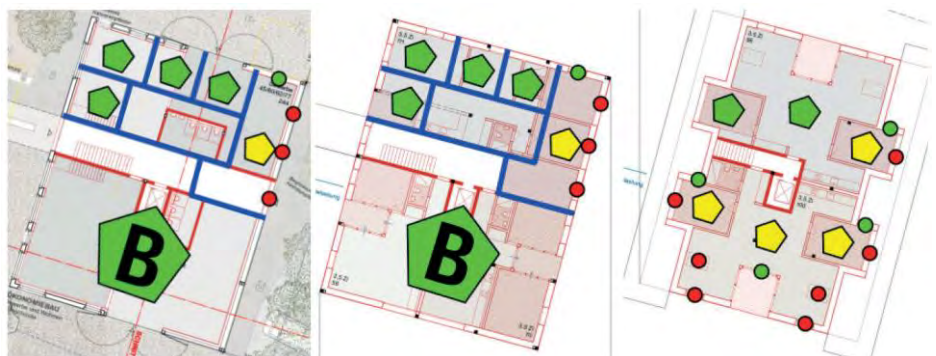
Grundrissanpassung Ökonomiegebäude
